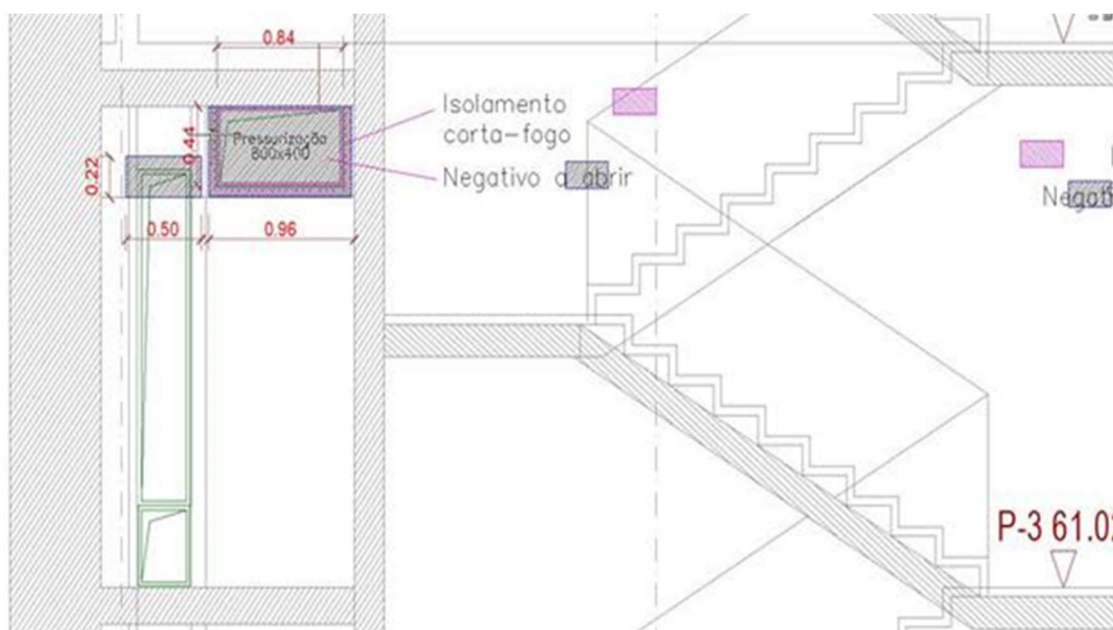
Corte de preparação dos subempreiteiros de AVAC, com condutas lado a lado a intersectar a viga de betão armado
